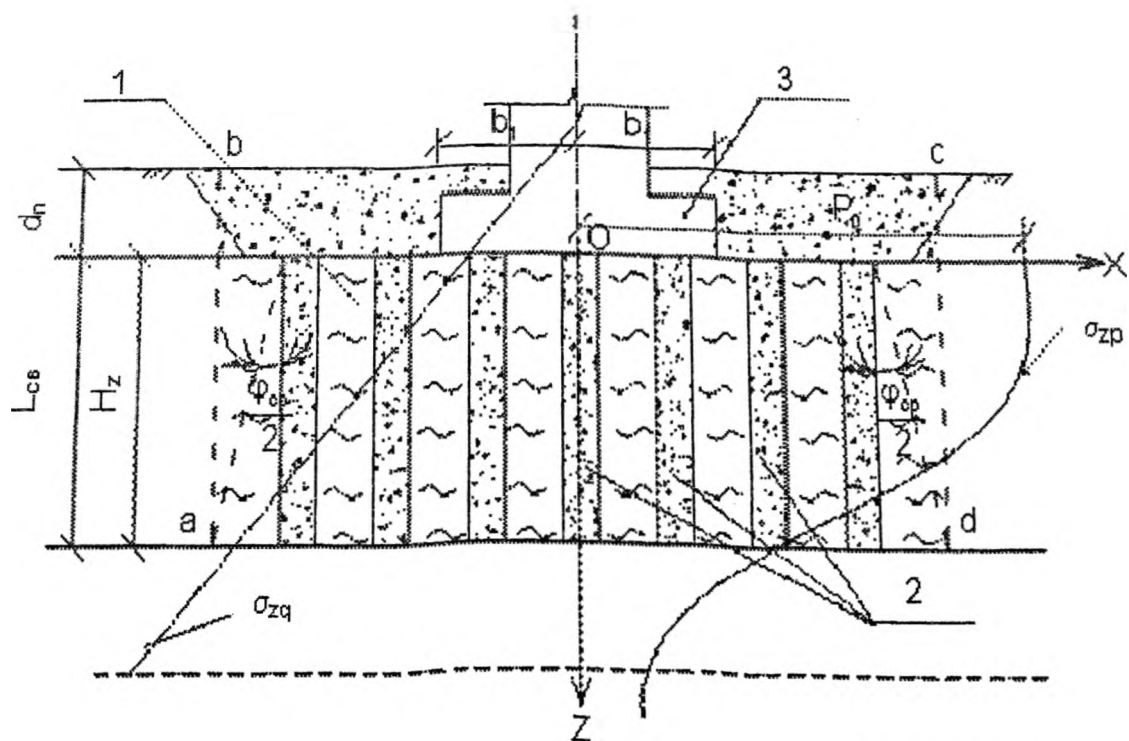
Схема к расчету основания армированного вертикальными элементами
